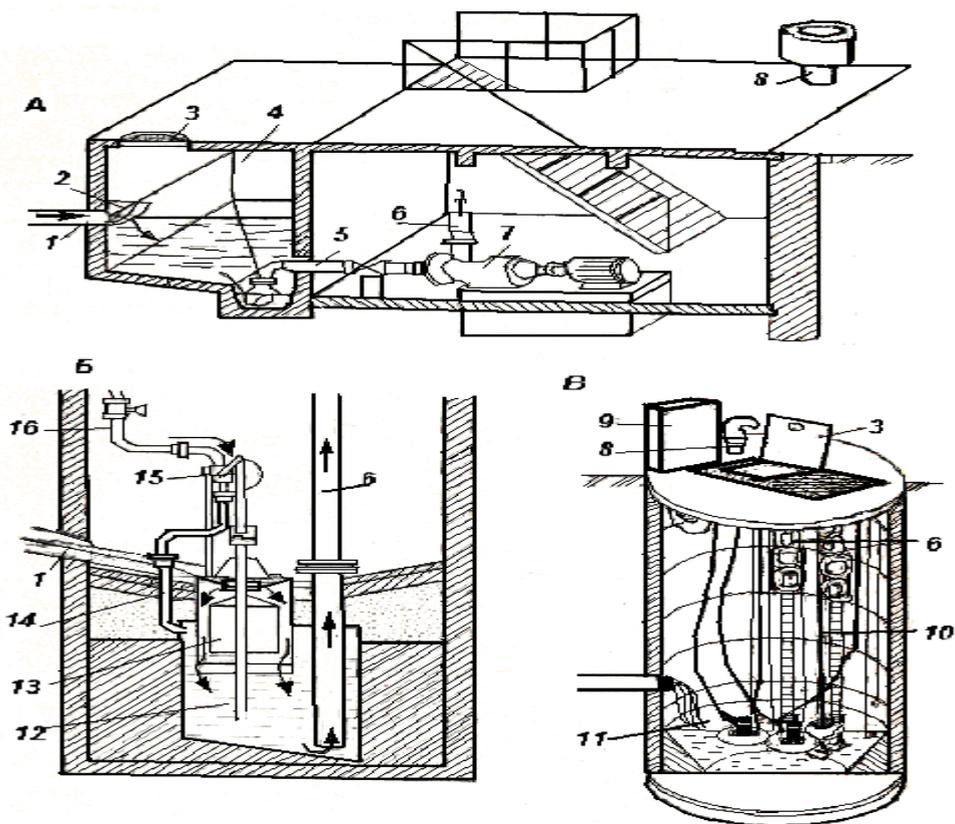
Установки для перекачки стоков. а- насосная установка с приемным резервуаром, б) пневматические установки в) погружные насосы установленные в колодце, 1-подающая труба; 2- решетка; 3-люк; 4 приемный резервуар; 5- всасывающая труба 6- напорная труба; 7-насос;8- вентиляционная труба; 9- станция управления; 10 – направляющие; 11- погружные насосы;12- стальной резервуар; 13 поплавков; 14-крышка; 15- кран,16- трубопровод сжатого воздуха.
